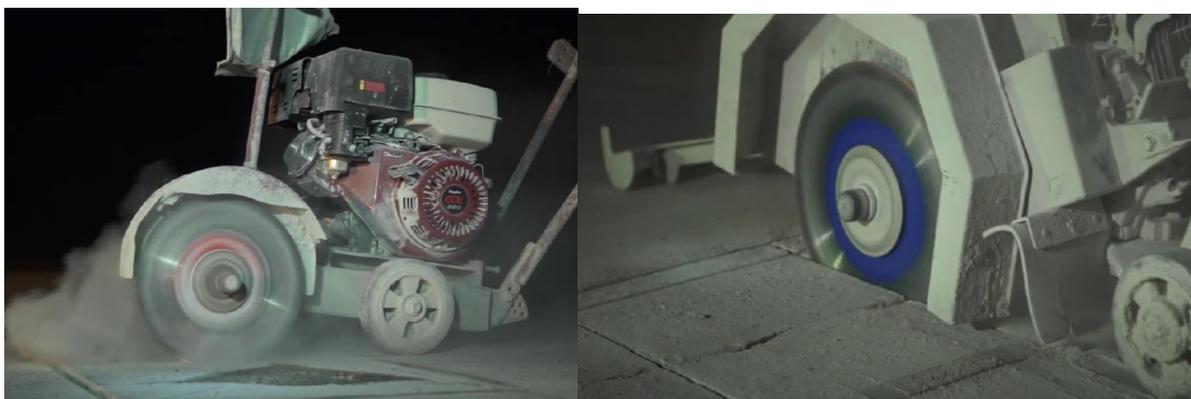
Нанесення борозен на поверхню свіжоукладеного бетону
